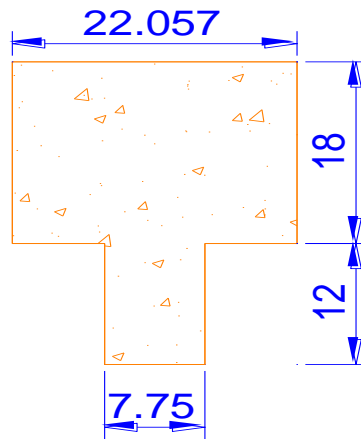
SECCIÓN HOMOGENEIZADA PARA HORMIGÓN
